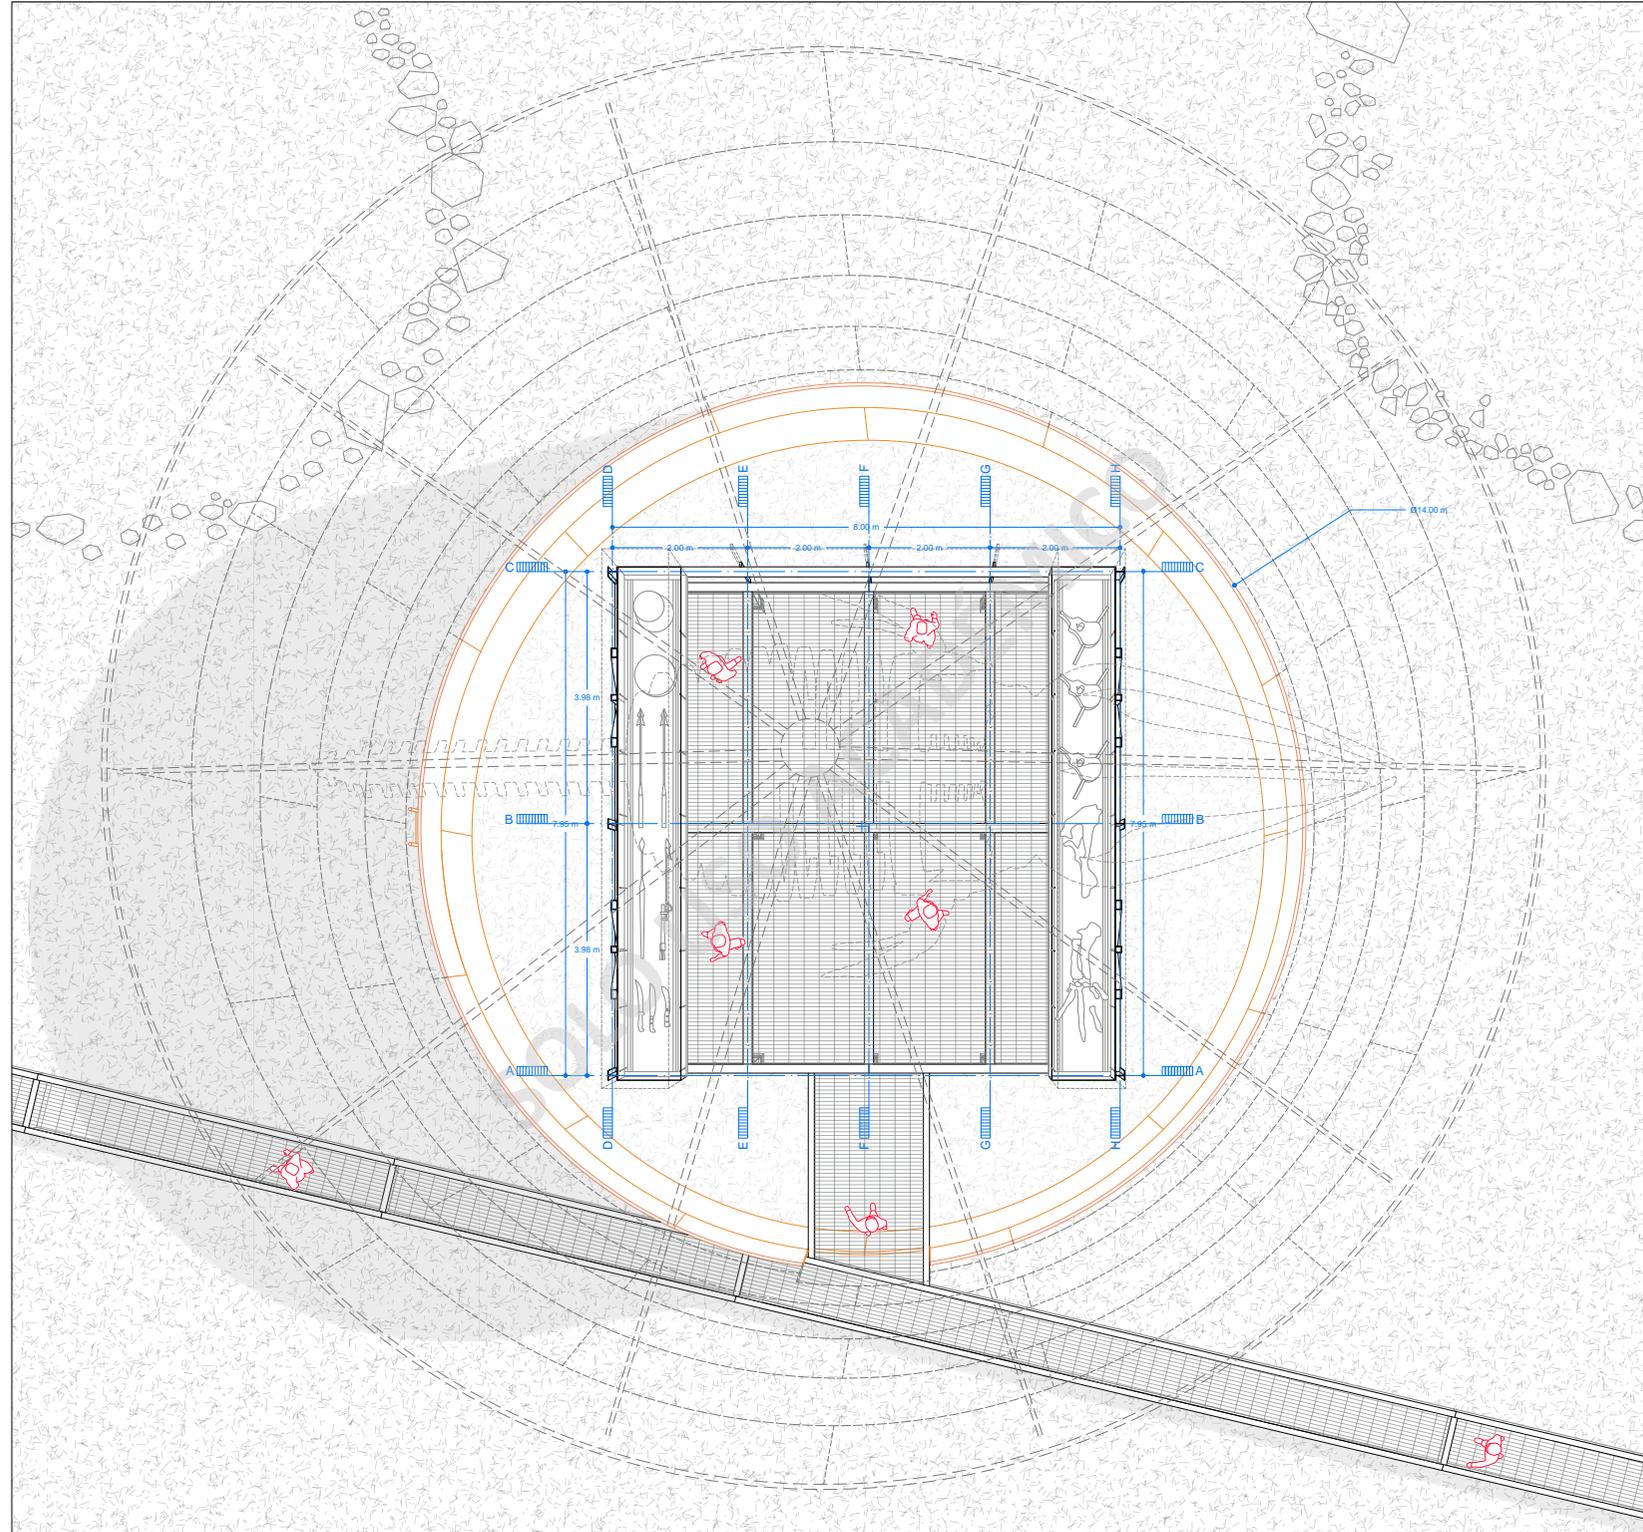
Planta nivel +4.00. Fuente: Elaboración propia
